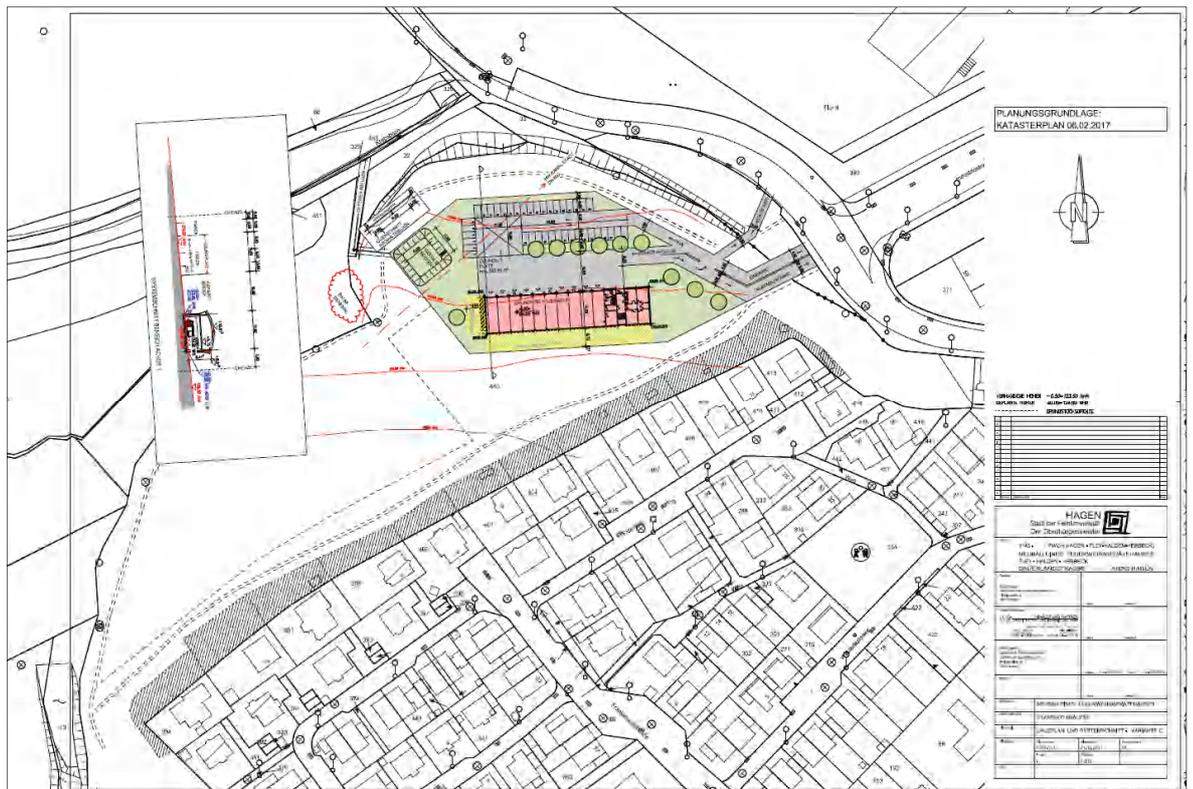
Lageplan und Systemschnitt – Variante C des Feuerwehrgerätehauses [7]
